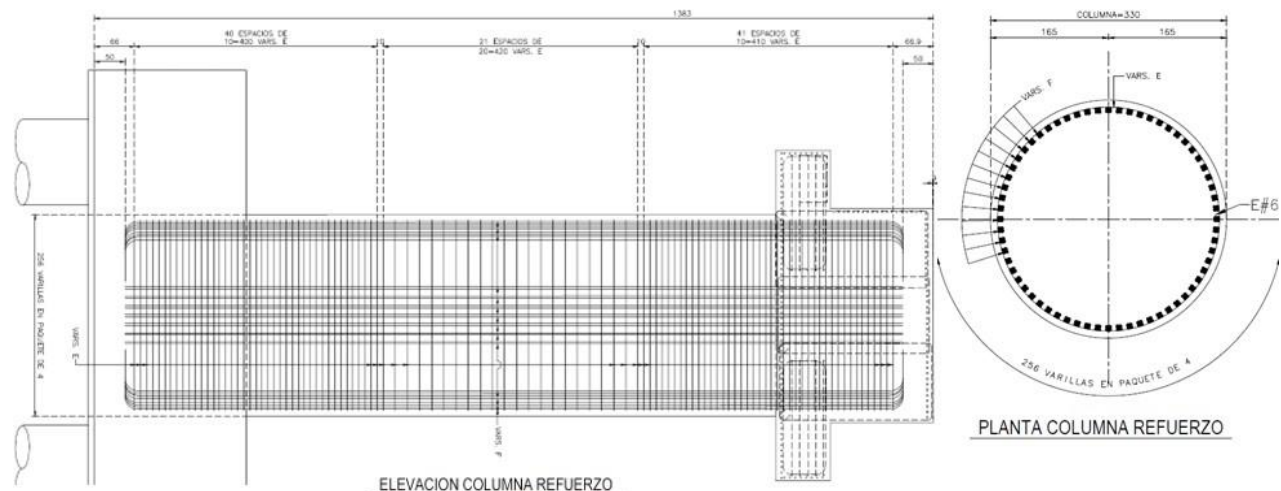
ARI Ingeniería (2023) "Arreglo de armado de acero de refuerzo para columnas de apoyos intermedios"
